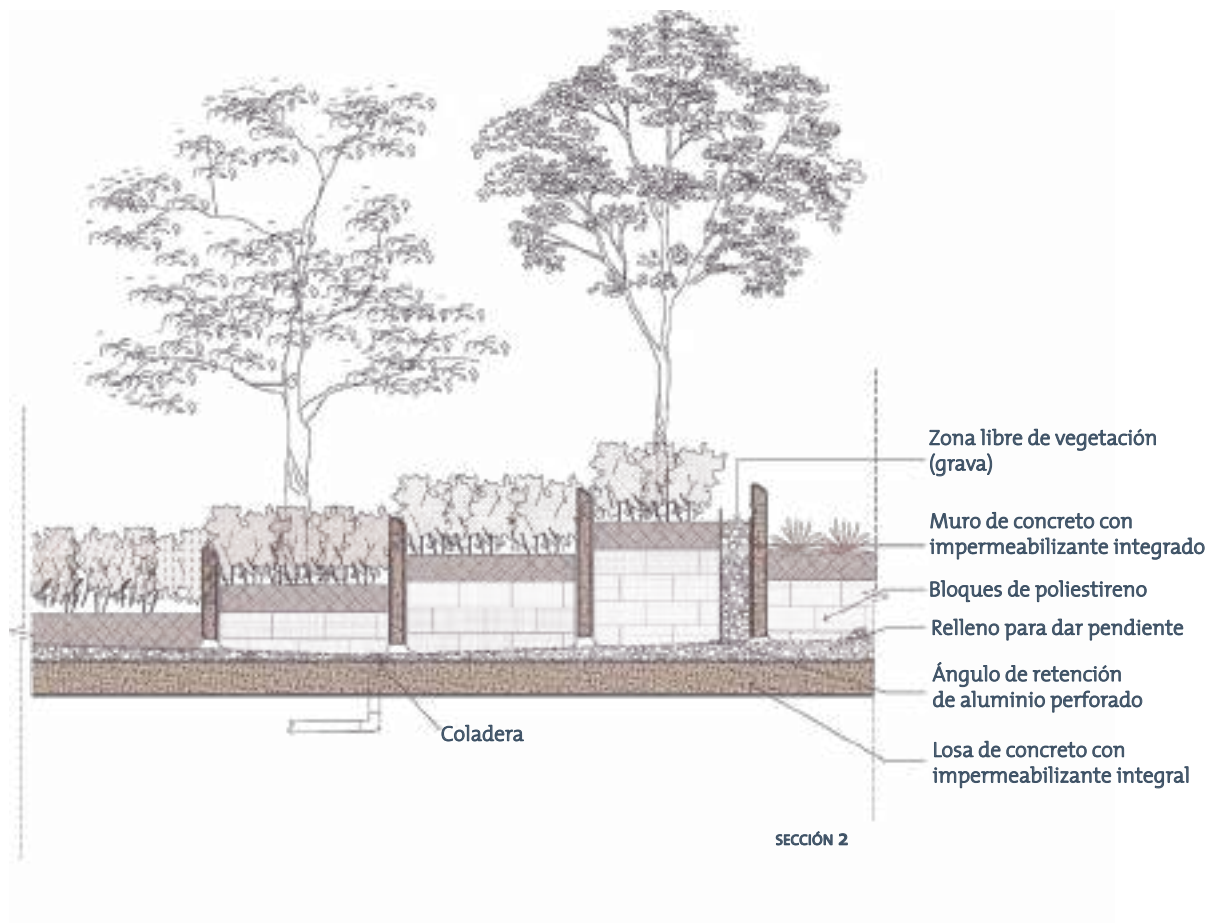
Detalles de jardineras sobre estructura, conjunto Miyana, Polanco, Ciudad de México
